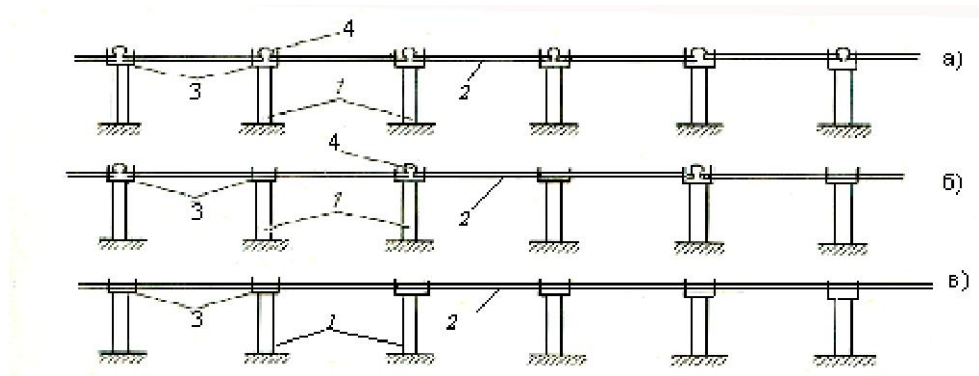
Шинные конструкции с одно-, двух- и многопролетными неразрезными шинами: 1 - изоляторы; 2 - шины; 3 - шинодержатели; 4 - компенсаторы тепловых расширений.
